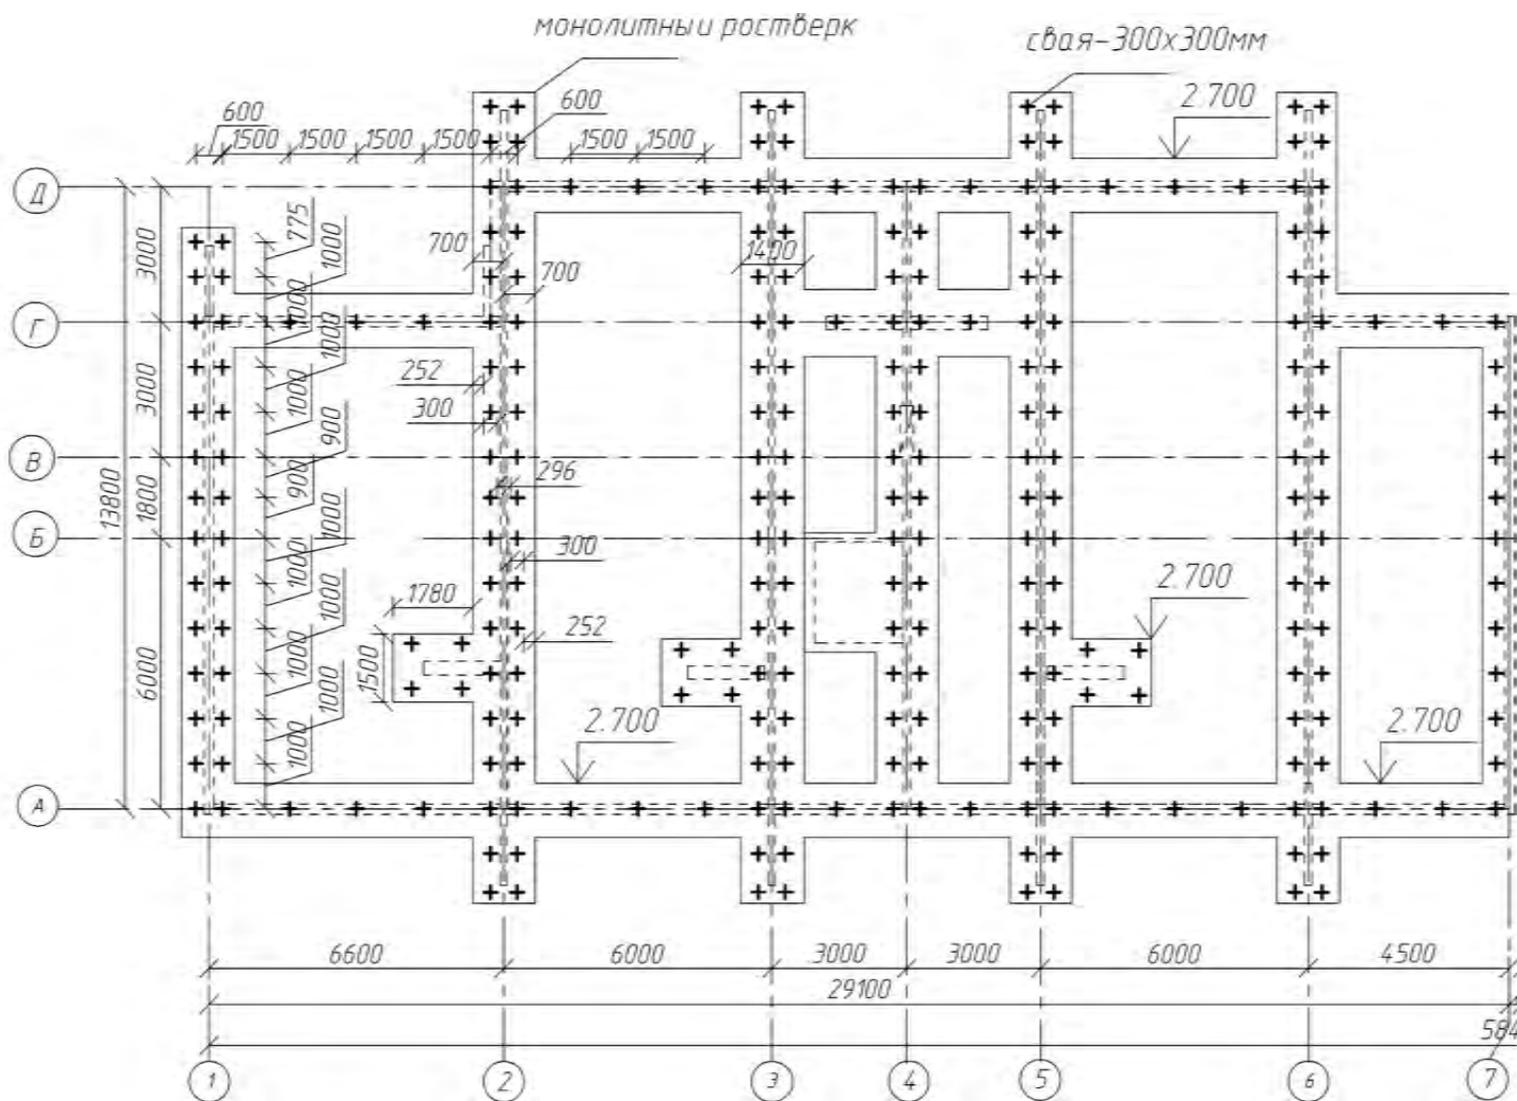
Схема расположения свайного фундамента (двухрядное расположение свай)
